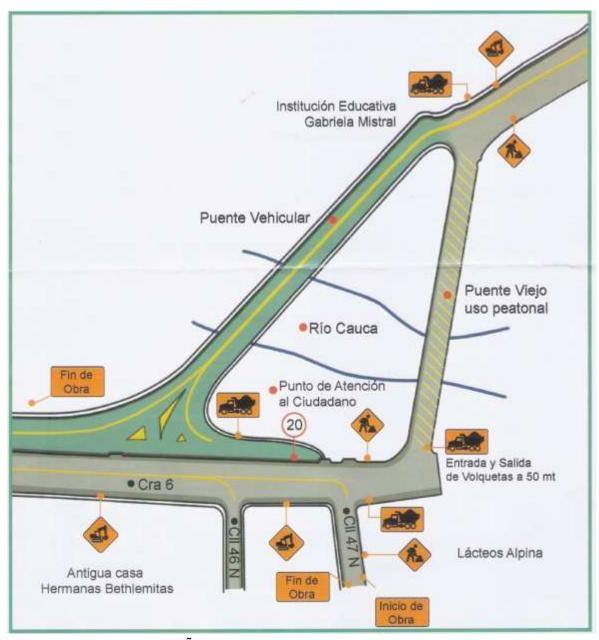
DISEÑO DE LA VIA PUENTE VEHICULAR - VISTA EN PLANTA
